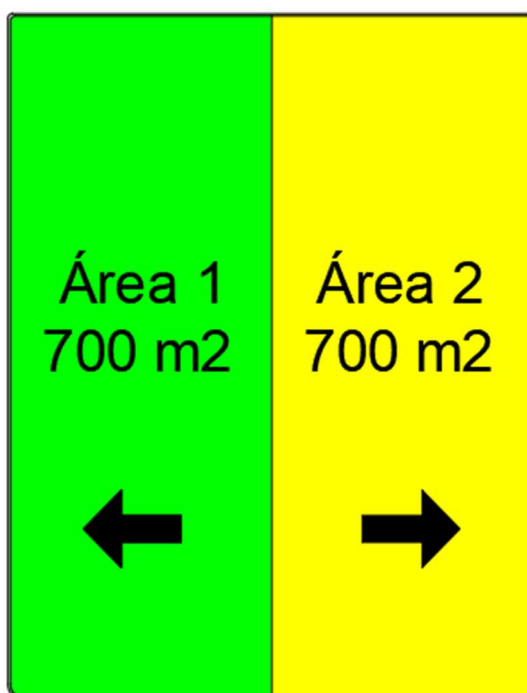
ÁREAS DE APORTE PLUVIAL - NAVE DE ESTACIONAMIENTO
